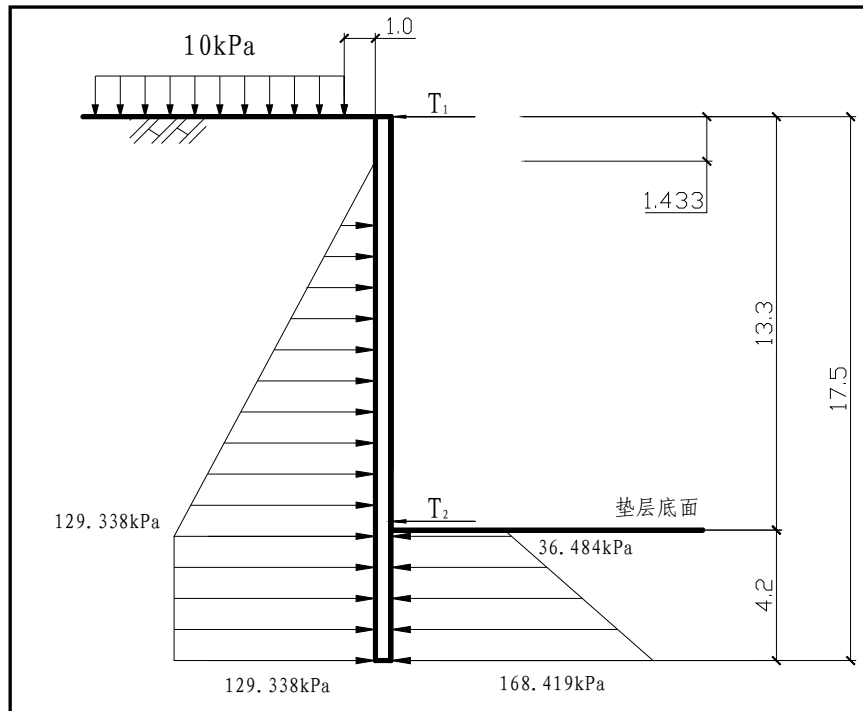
增设永久支撑的力学计算简图（尺寸单位：m）
